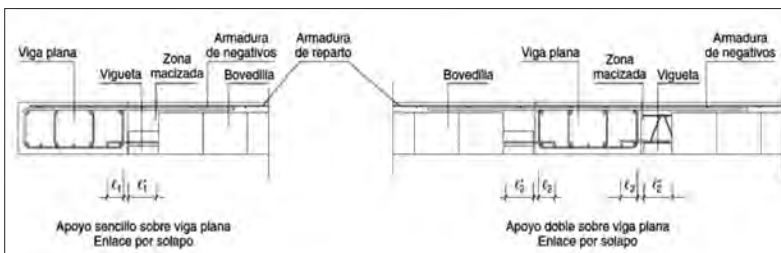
y 24: apoyo sobre viga plana. Enlace por solapo.
